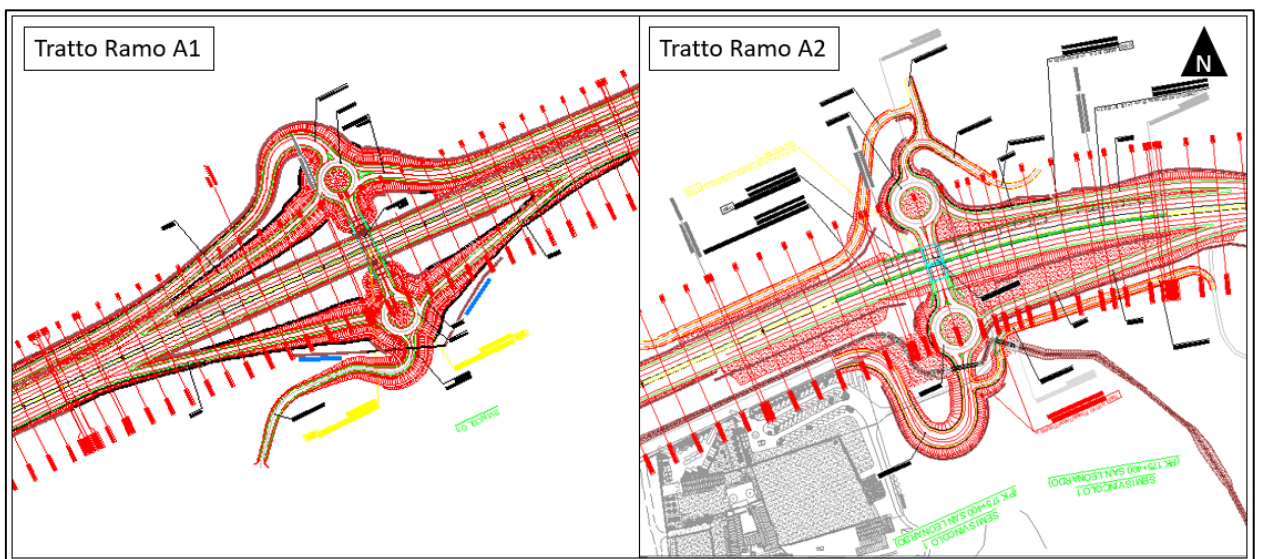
Stralcio planimetria di progetto – Ramo A1 ed A2
